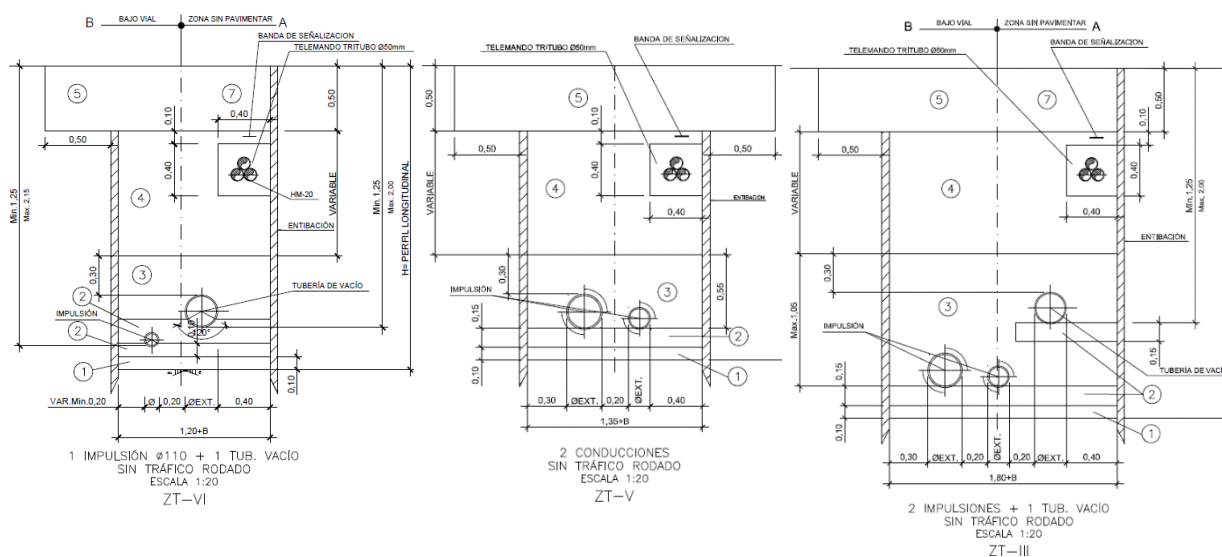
Ejemplos de algunas zanjas tipo de proyecto para más de una conducción
